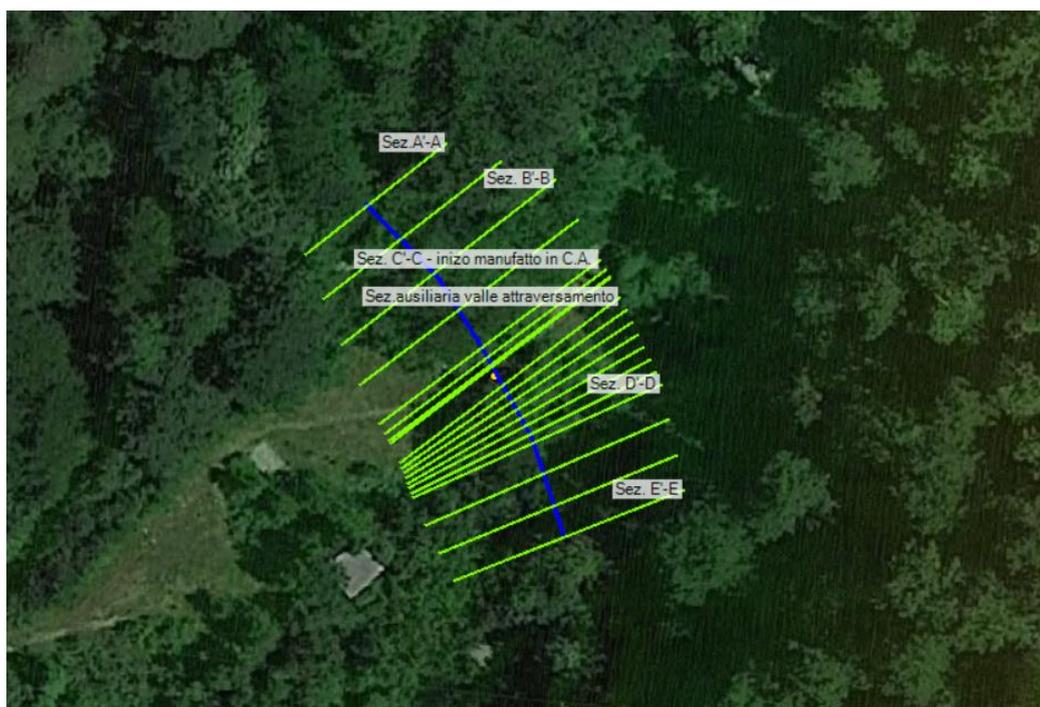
Geometria estratta dal modello di verifica con localizzazione delle sezioni di verifica su Ortofoto
